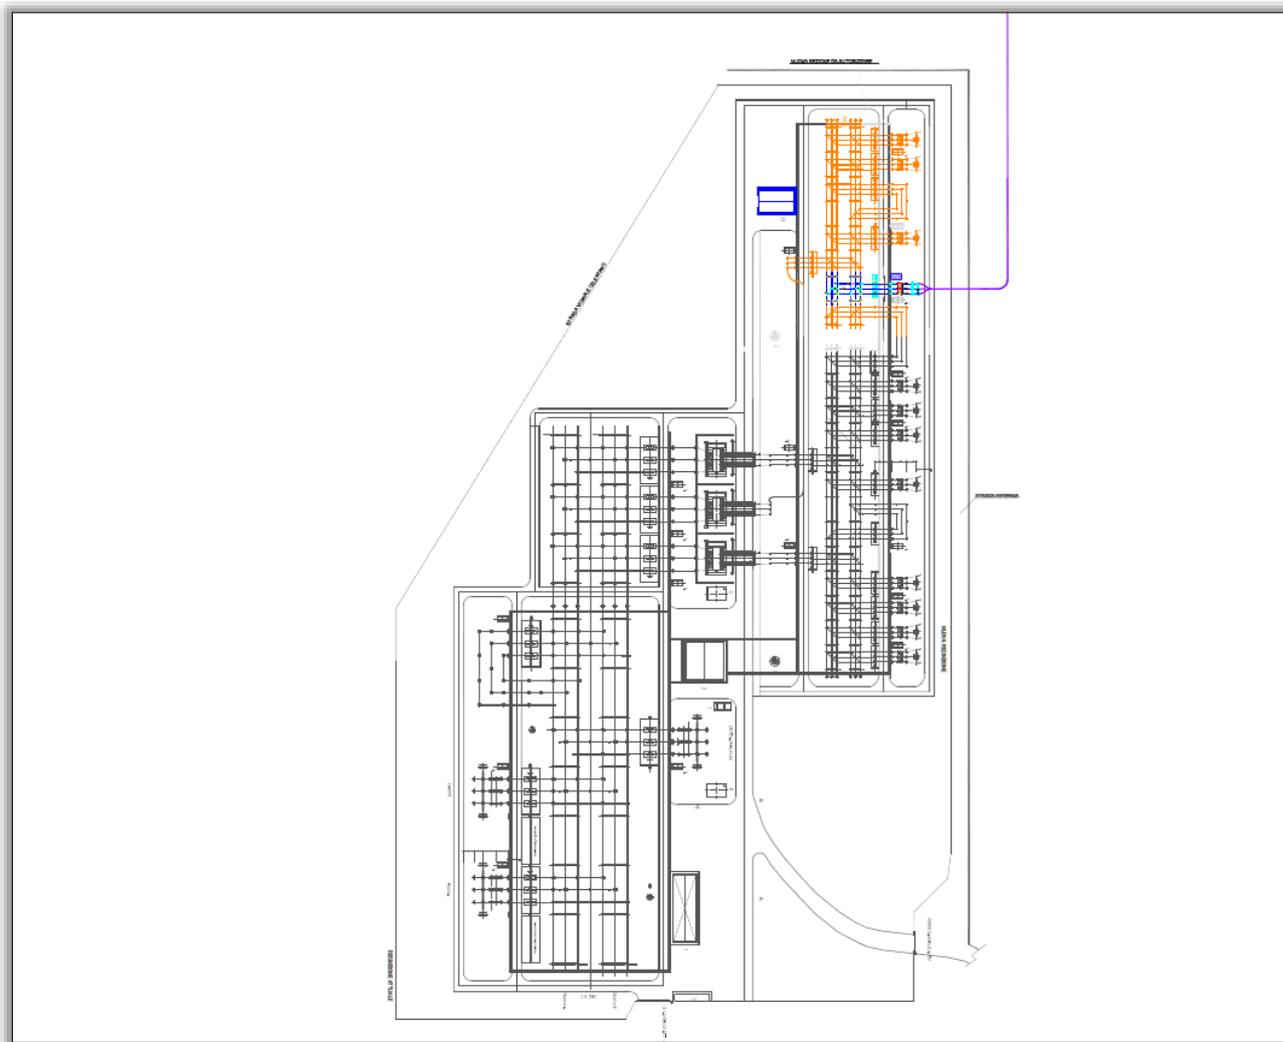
Planimetria elettromeccanica dello Stallo di Arrivo nella SE-RTN.
